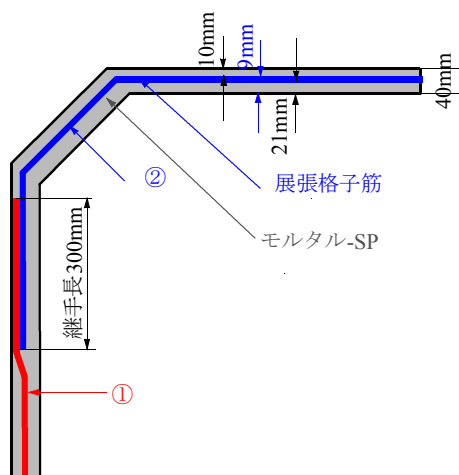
補強カルバート B 供試体の寸法および鉄筋配置
